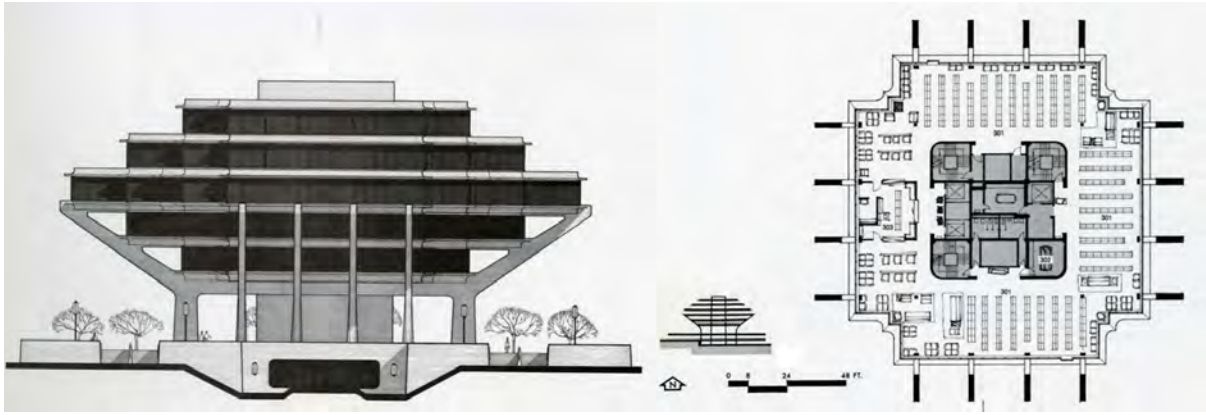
Prospetto e pianta piano terzo della Geisel Library.
